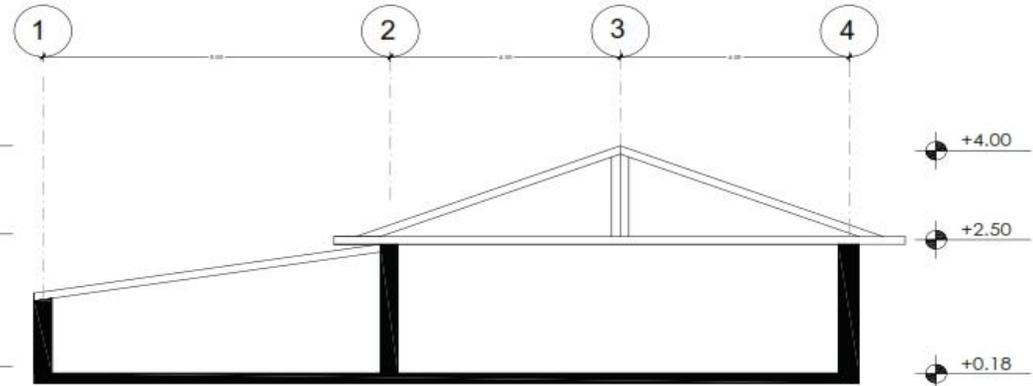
Corte b-b de la vivienda-Caso 1
